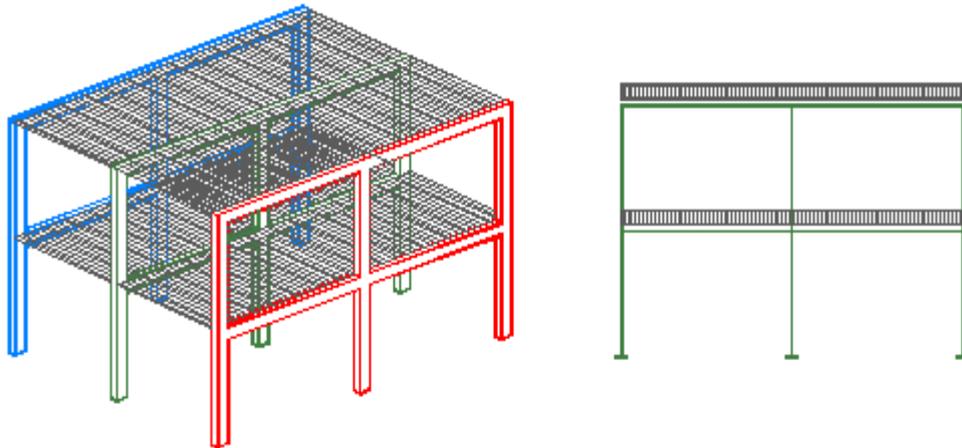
Pórticos de hormigón armado. Fuente: ZIGURAT Institute of Techonoly (2017).
